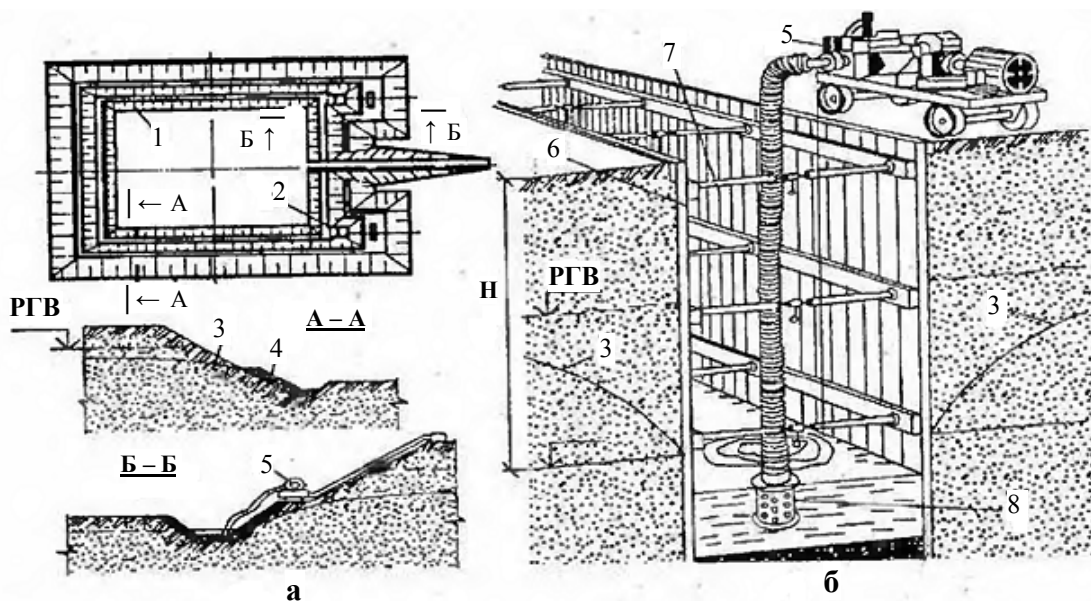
Схема відкритого водовідливу: а – з котловану; б – з траншеї; 1 – канава дренажна; 2 – приямок (зумпф); 3 – знижений рівень ґрунтових вод; 4 – привантаження дренажне; 5 – насос; 6 – кріплення шпунтове; 7 – розпірка інвентарна; 8 – рукав всмоктуючий з сіткою (фільтром); Н – висота всмоктування
